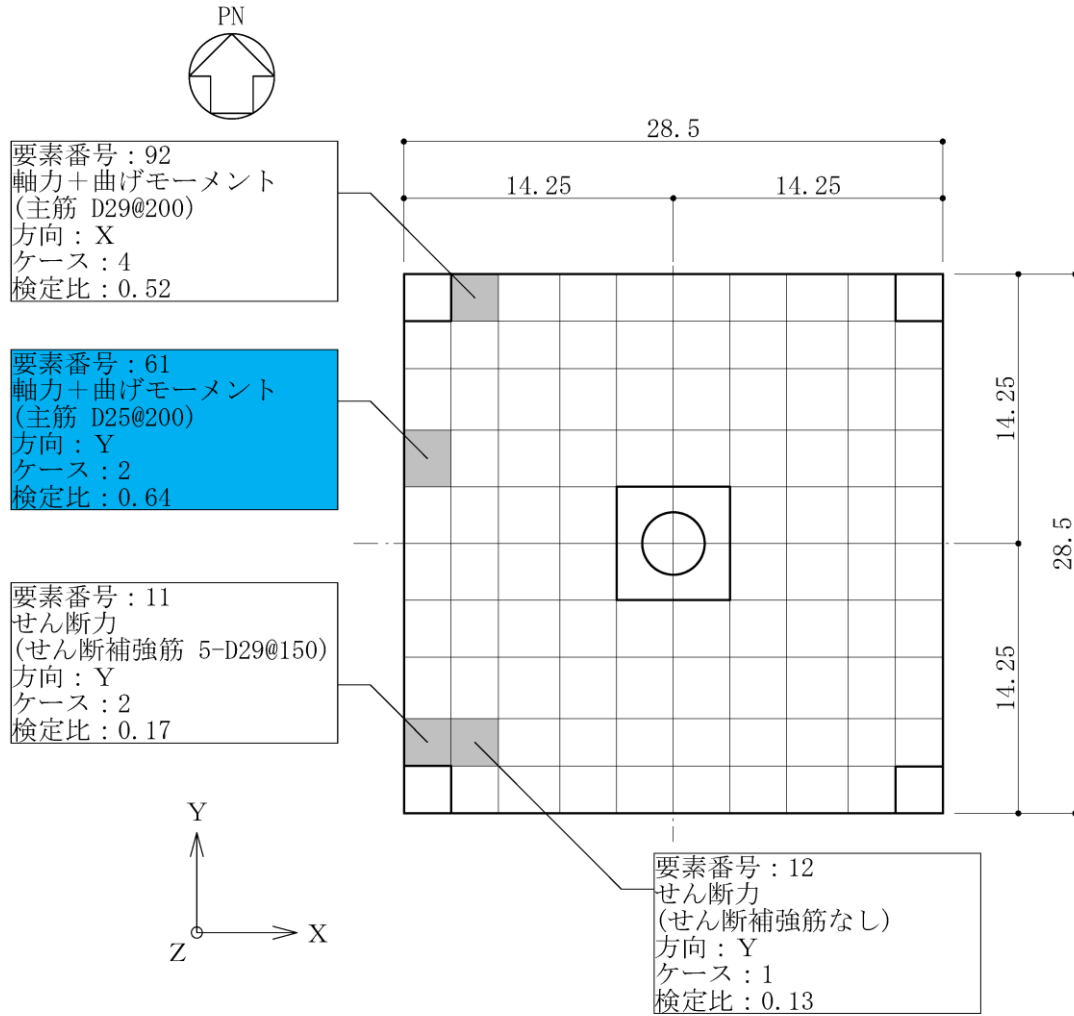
(2) 基礎版の概略配筋図 (せん断補強筋) (単位 : m)
